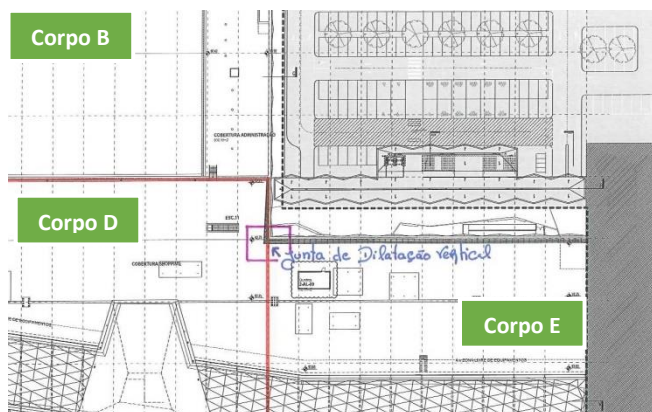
Impermeabilização Junta de dilatação Vertical localizada entre os Corpos D e E
